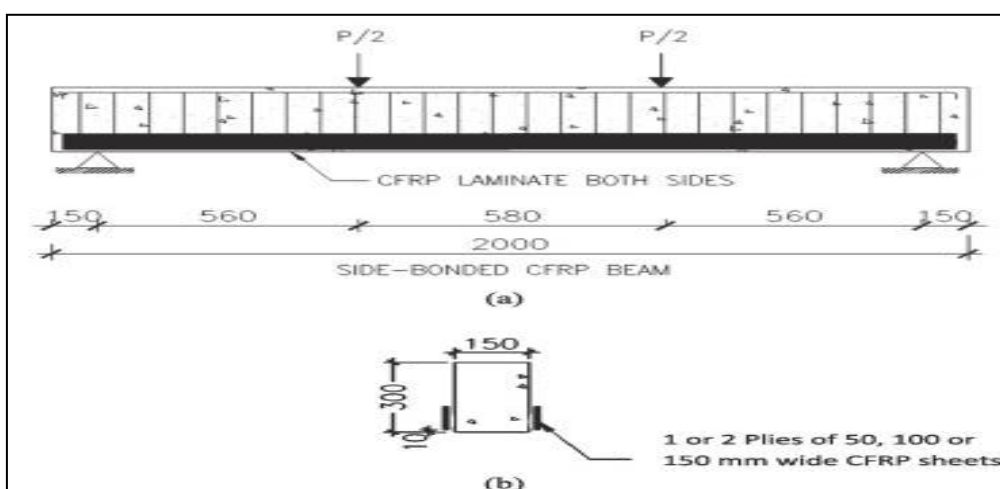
Vue en élévation des éprouvettes renforcées sur les surfaces latérales
